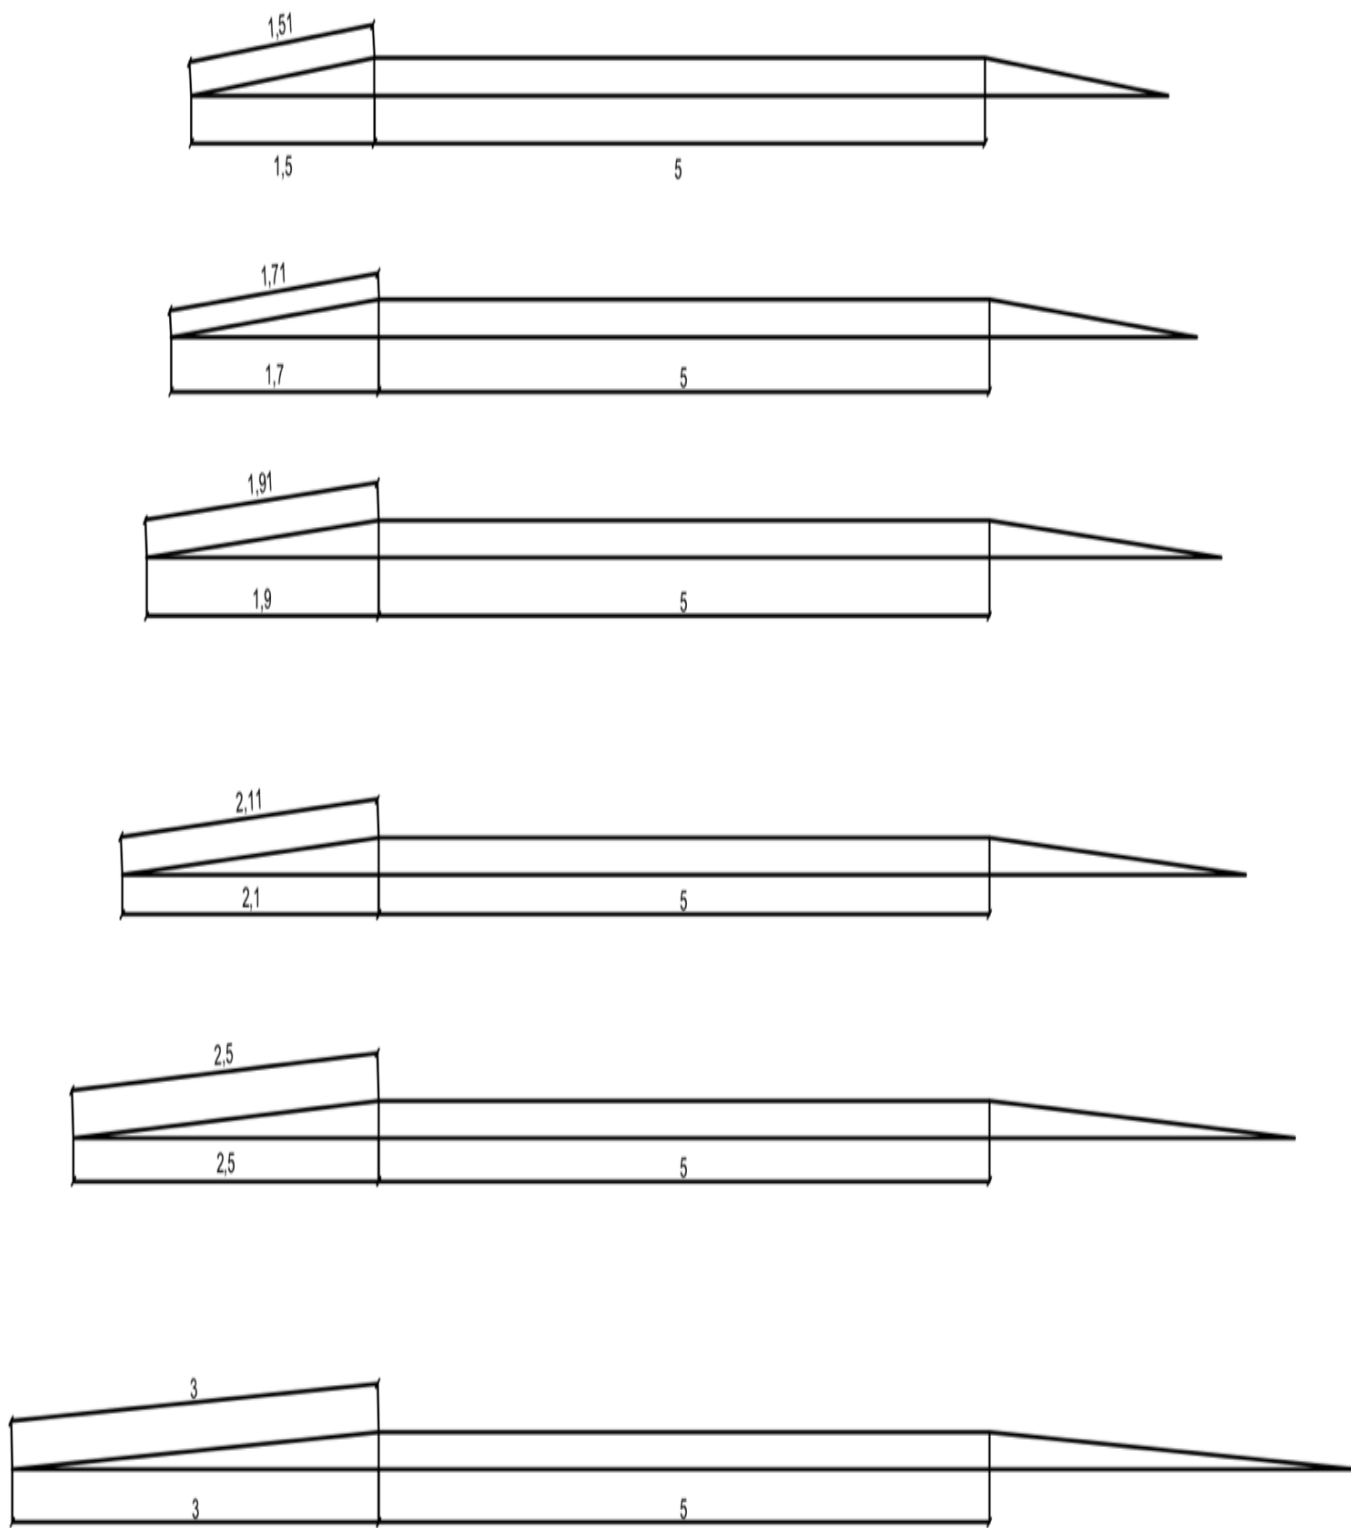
Conformações e dimensões em corte das alternativas possíveis da construção de faixas elevadas
